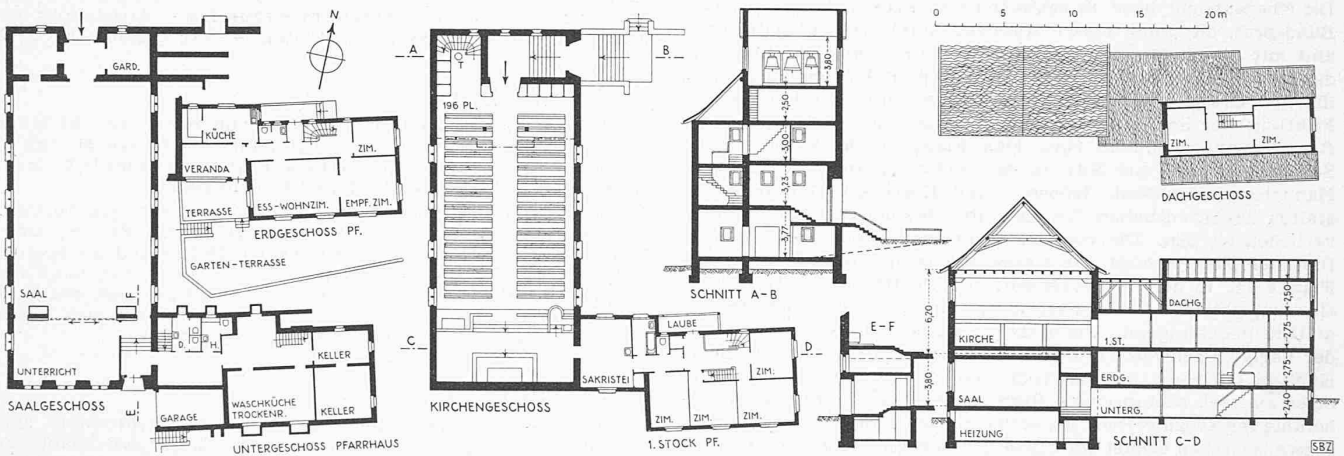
Grundrisse und Schnitte 1:500 der katholischen Kirche in Hallau. Arch. ARNOLD MEYER, Hallau
